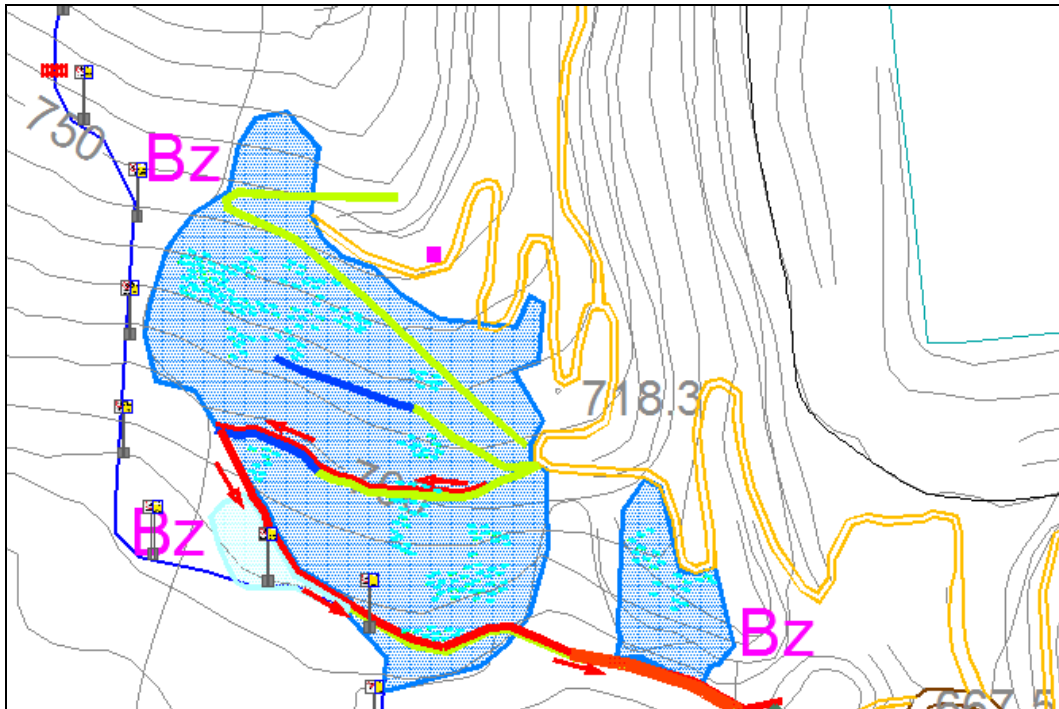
Localizzazione cancello a monte della discarica Bellezza (cfr. elaborato C2 - Planimetria generale di progetto)
